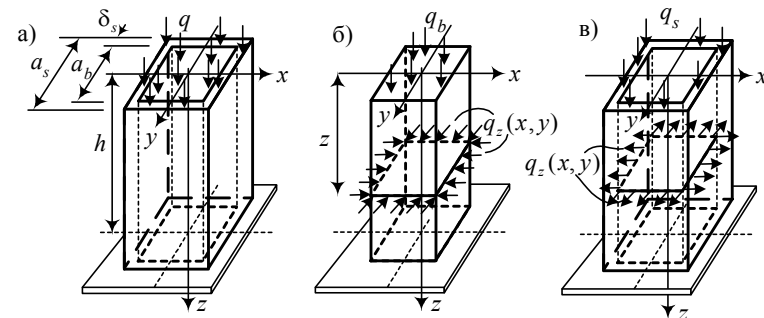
Расчетная схема консольной сталебетонной колонны: а) колонна; б) бетонное ядро; в) стальная обойма
